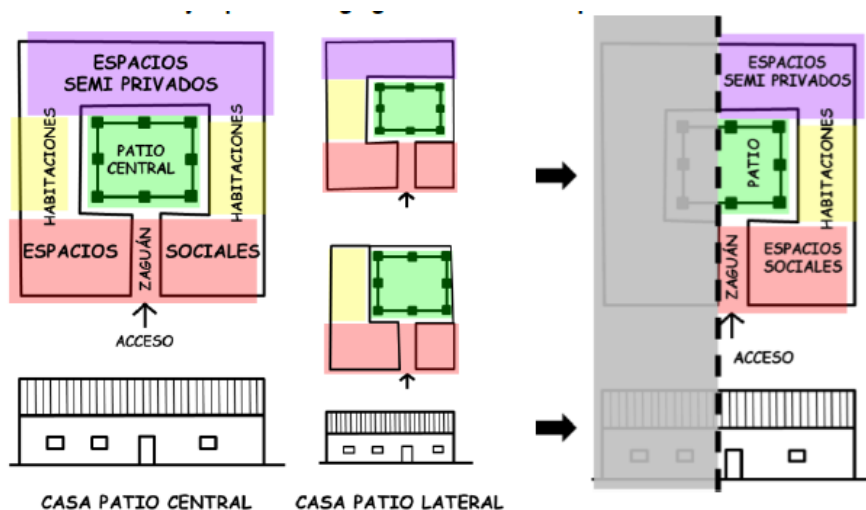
Espacios encontrados en viviendas del Barrio Egipto; Fuente: Empresa Virgilio Barco
